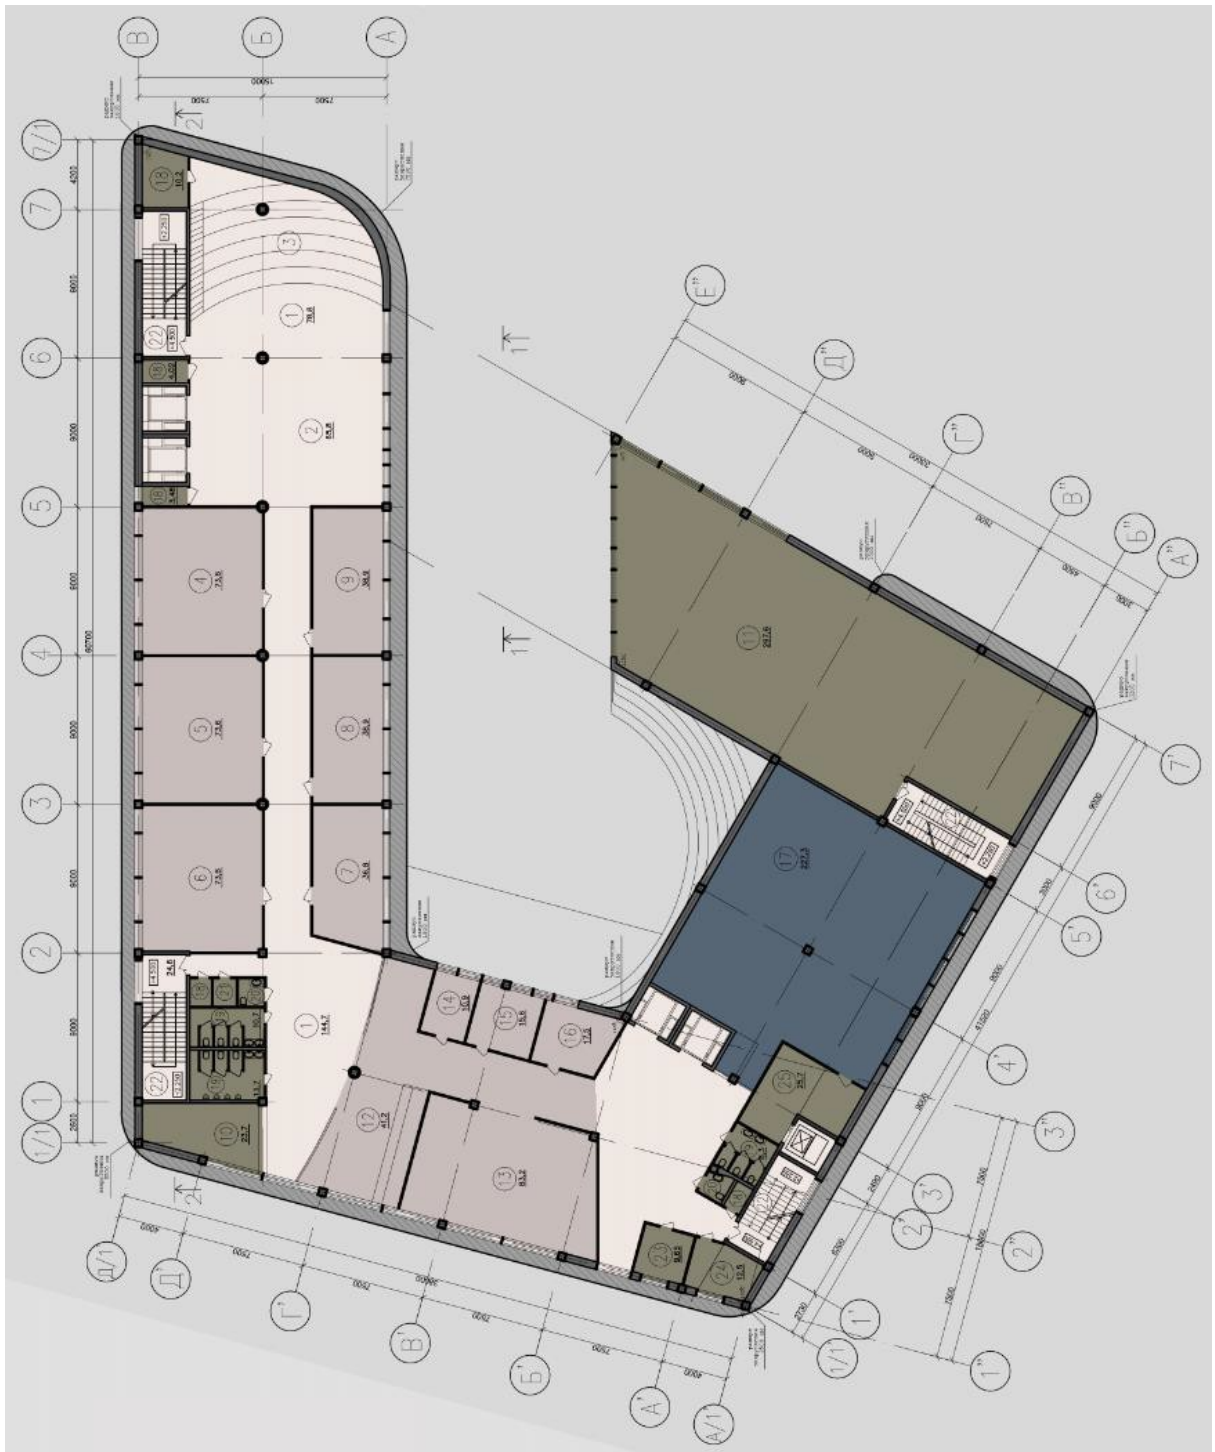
План типового этажа (3-4) на отм. +10.500
